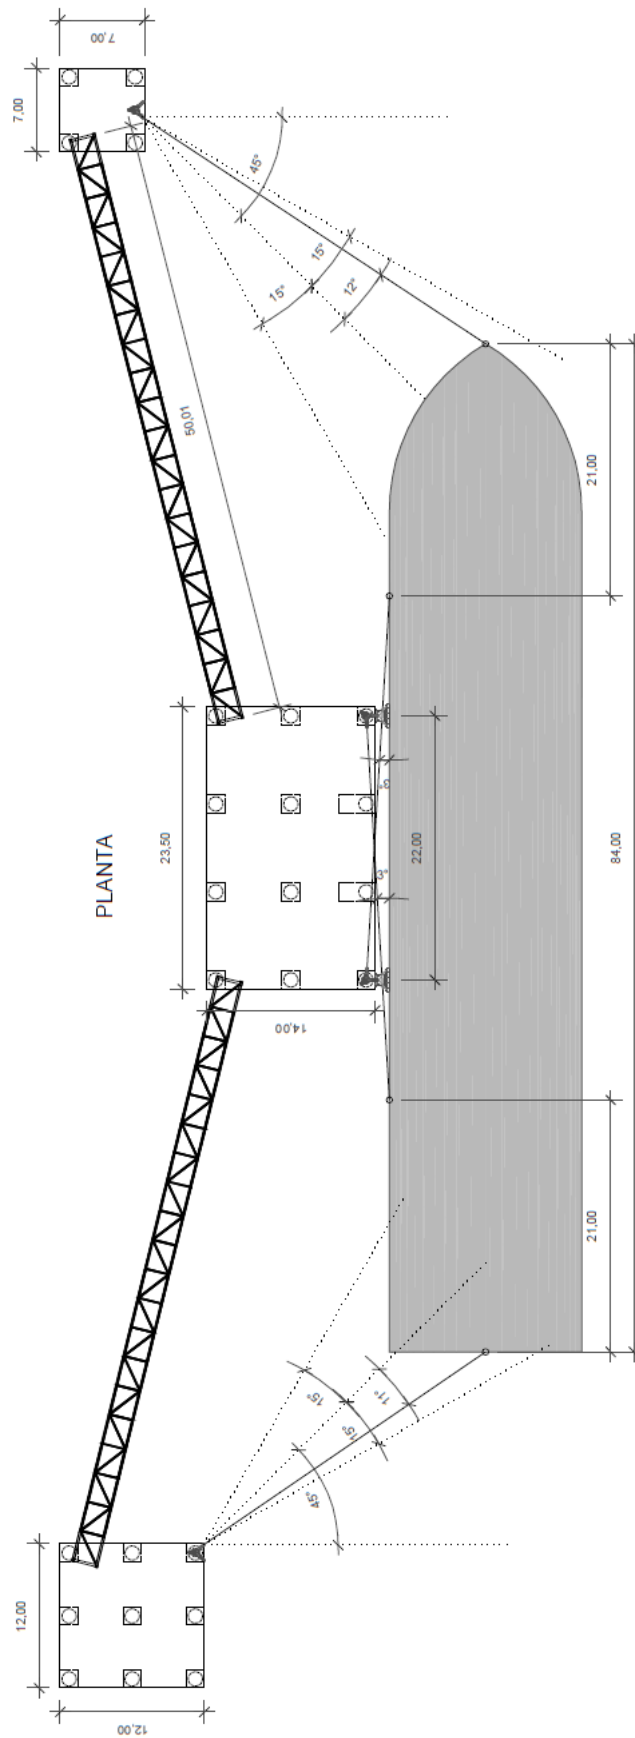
Encaje geométrico en planta del atraque de proyecto.
